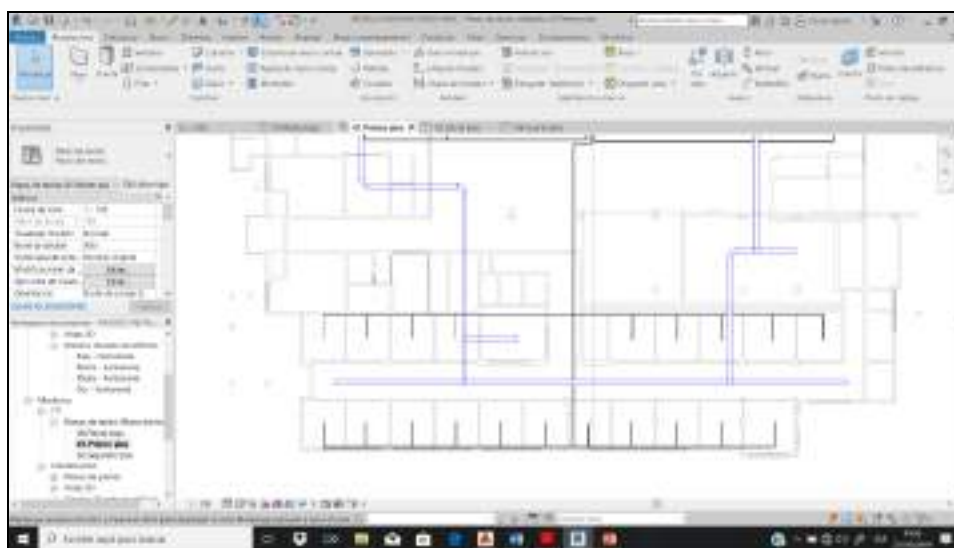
Modelado de Instalaciones mecánicas (Ductos de ventilación y aire comprimido -Vista en Planta)
